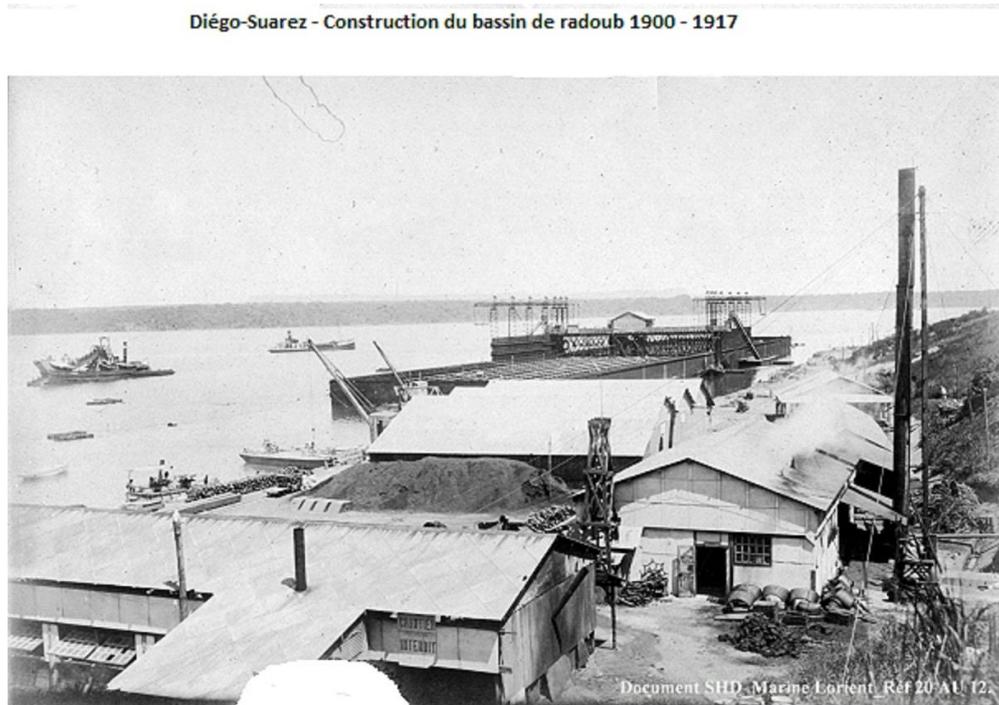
Construction à flot des caissons latéraux et des bajoyers (Archives SHD Lorient)
